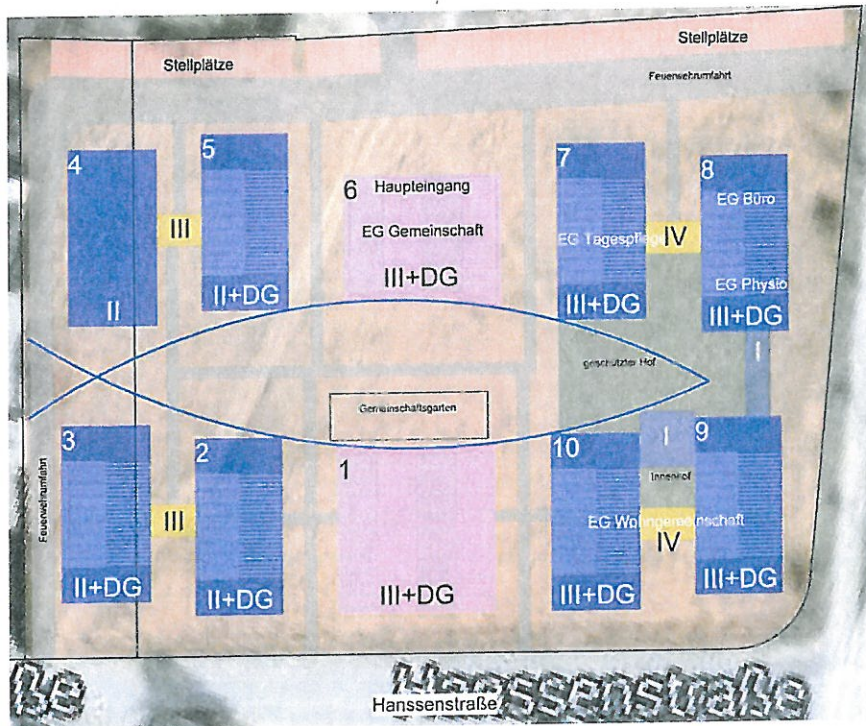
Übersichtsplan der vorgesehenen Bebauung mit Gebäudehöhen
